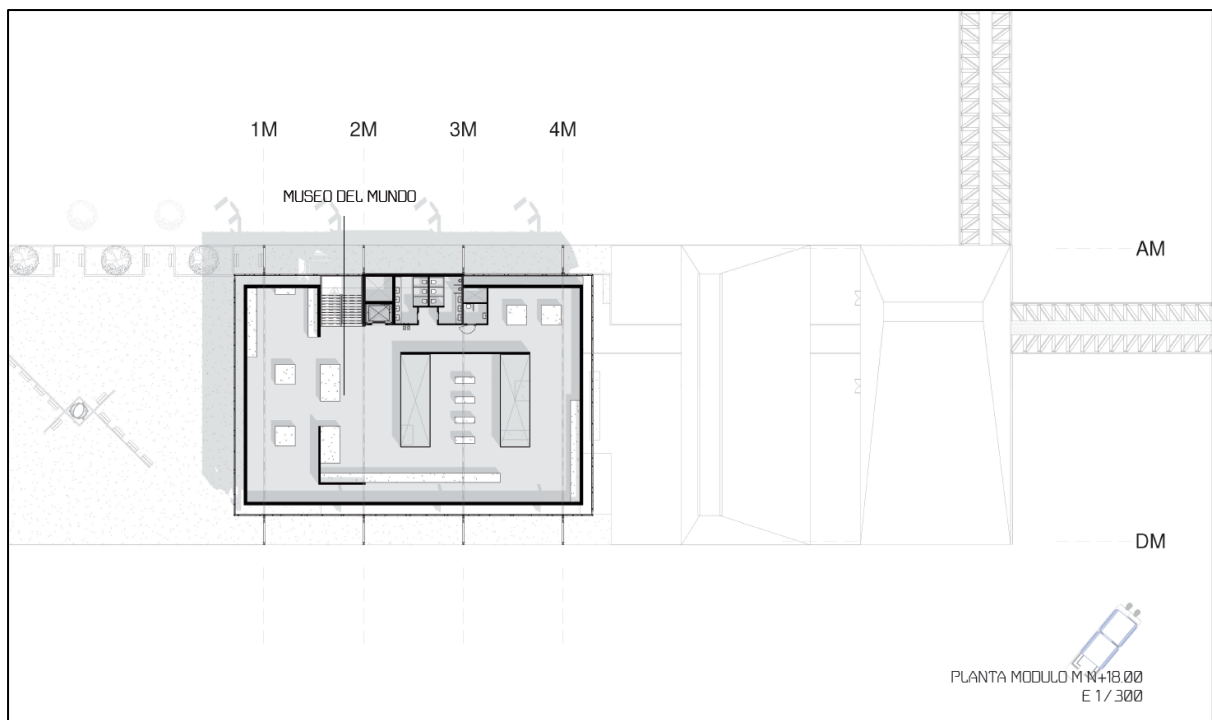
Planta N+18.00 Módulo M. Elaboración propia.
